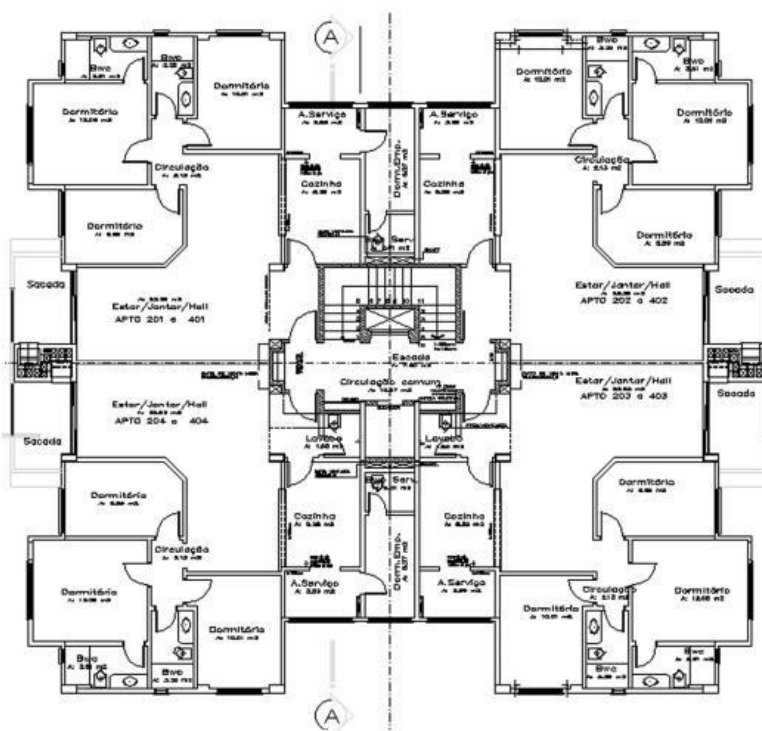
Planta Baixa do pavimento tipo. Fonte: Bolzan (2000)
